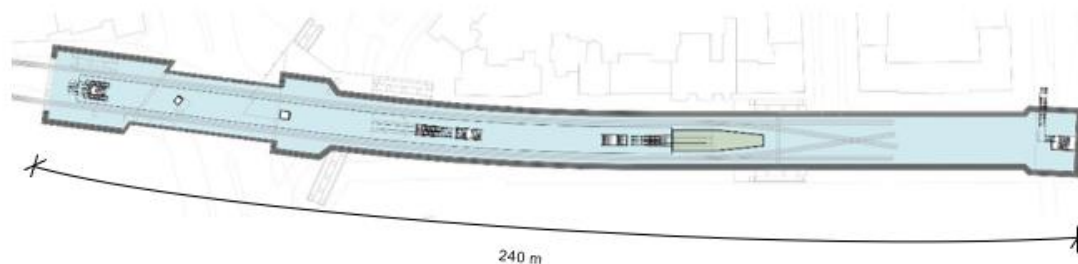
Hp Schlump, Var. I – Grundrisse
